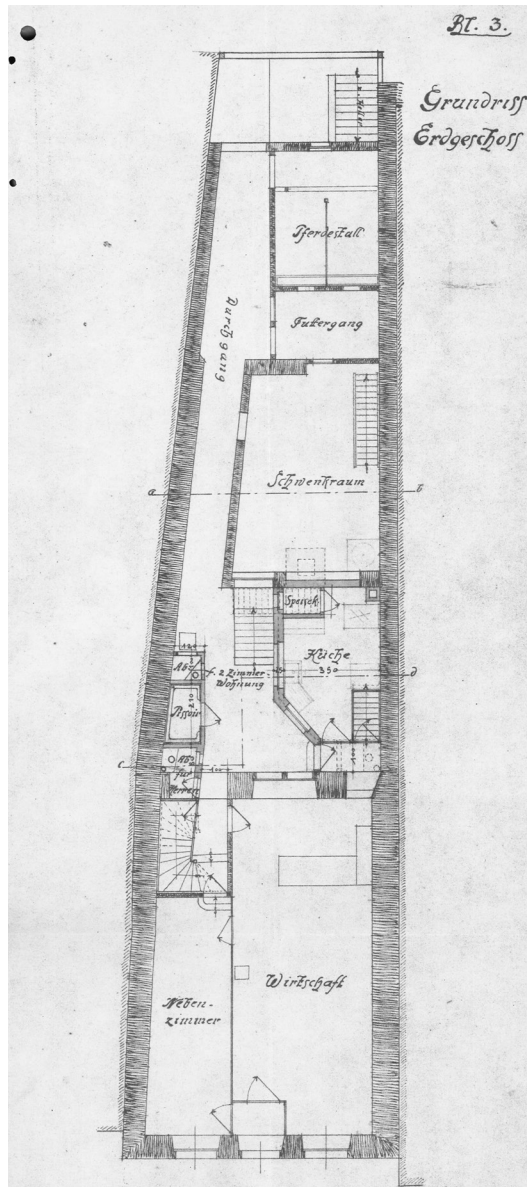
Hauptstraße 45. Grundriss Erdgeschoss mit Lage der Schnitte a-b und c-d, Plan von 1919.
